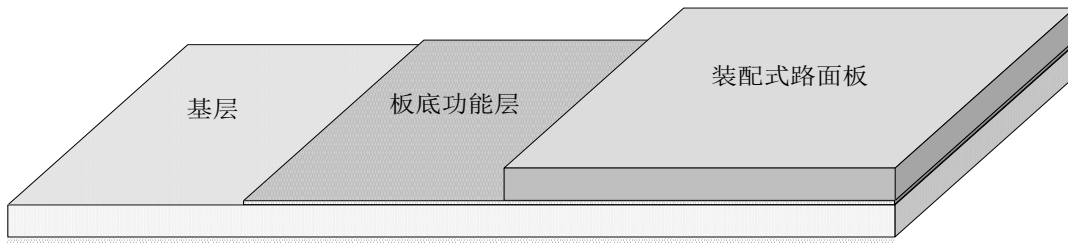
装配式水泥混凝土路面结构组合示意图
